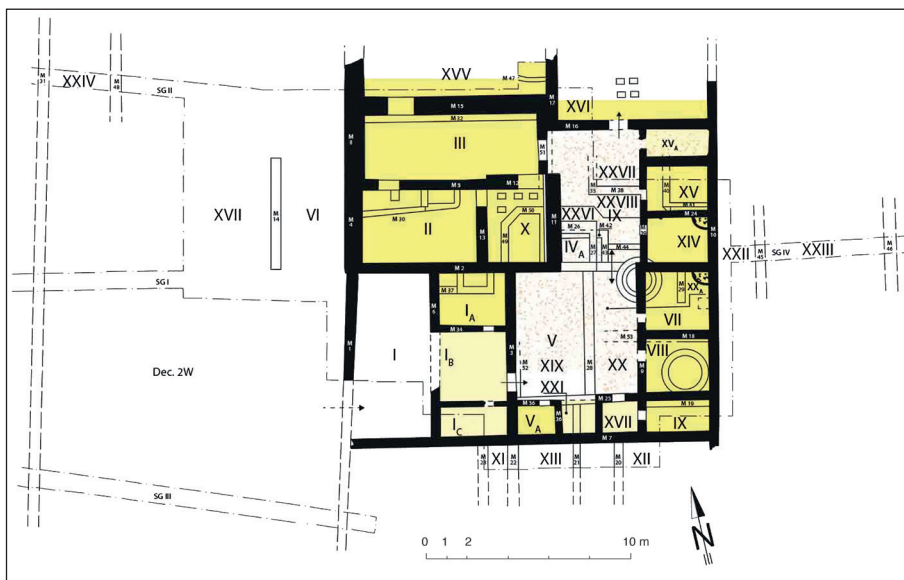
Insula VIII/Nordwest: Gebäude, Periode IV. spätantikes Hofhaus. Idealisierter Grundrissplan (nach Dolenz et al. 2016, Abb. 16).
